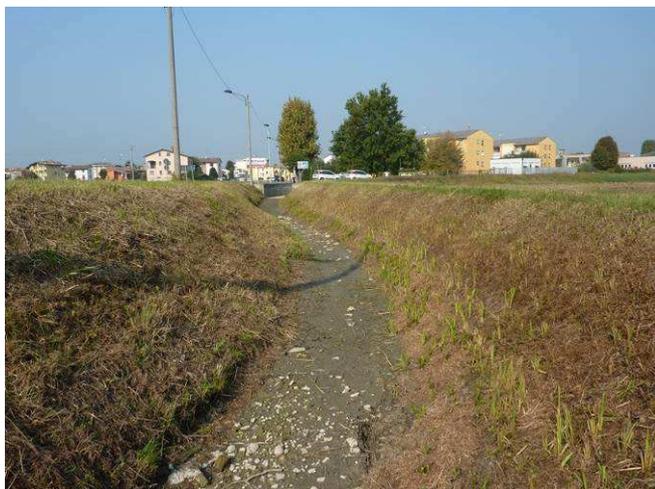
CANALE NUOVO – SEZIONE IN TERRA A VALLE DEL TOMBINO IN MURATURA
